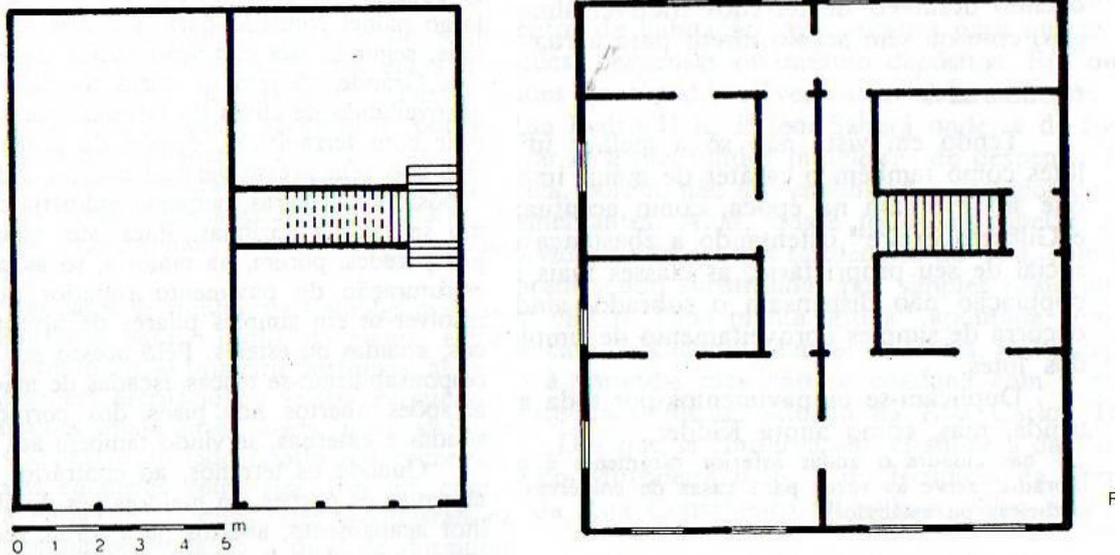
Planta baixa, pavimentos térreo e superior, que exemplificam *sobrados*.
